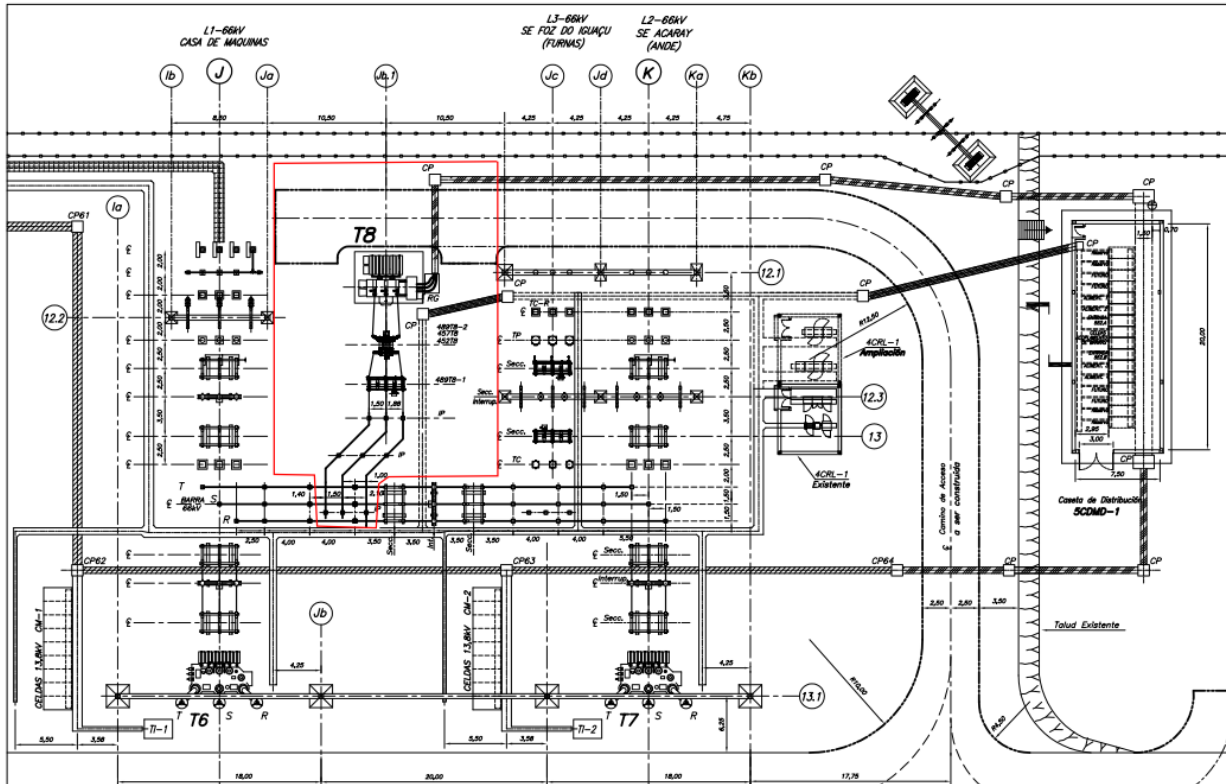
Celda T08 66kV – Planta - Solución Equipos MHC
